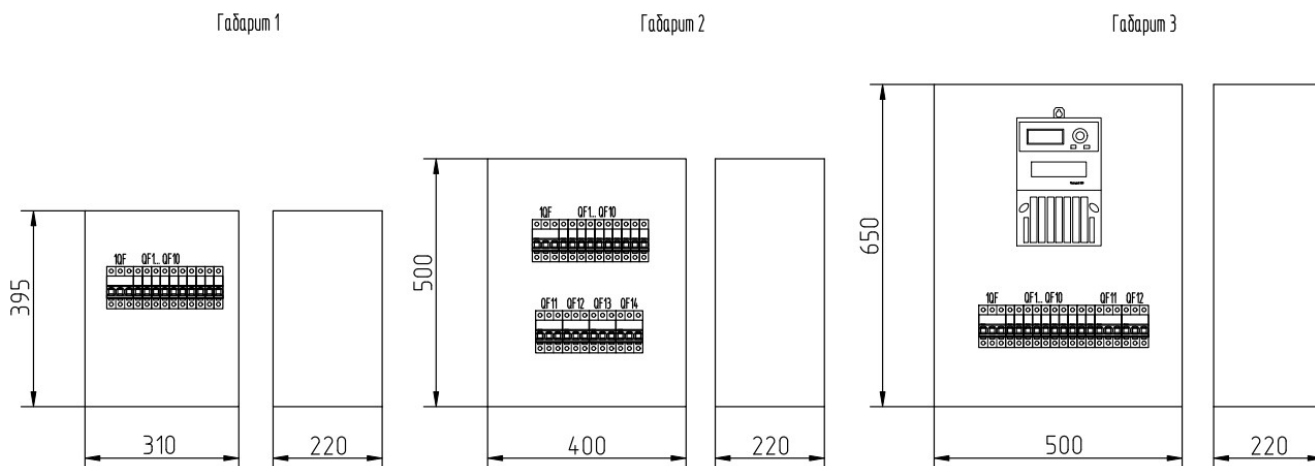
Внешний вид и габаритные размеры шкафа ВРУ8.
